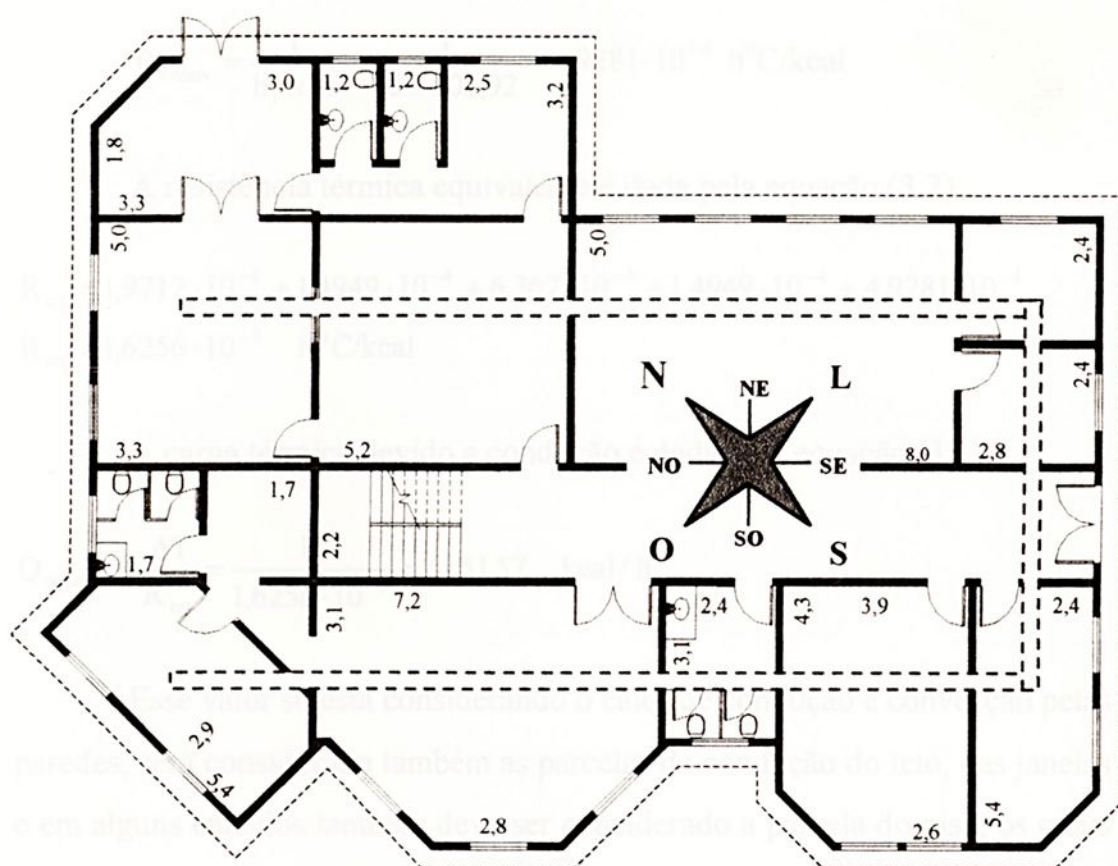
Planta baixa do prédio comercial (dimensões em m)
